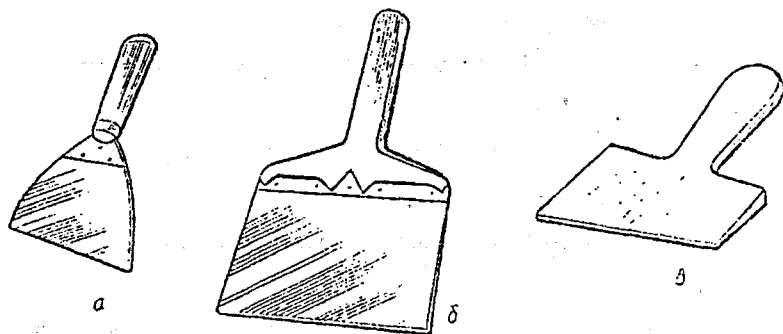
Шпателі: а - сталевий з дерев'яною ручкою; б - сталевий з металевою ручкою; в - дерев'яний
